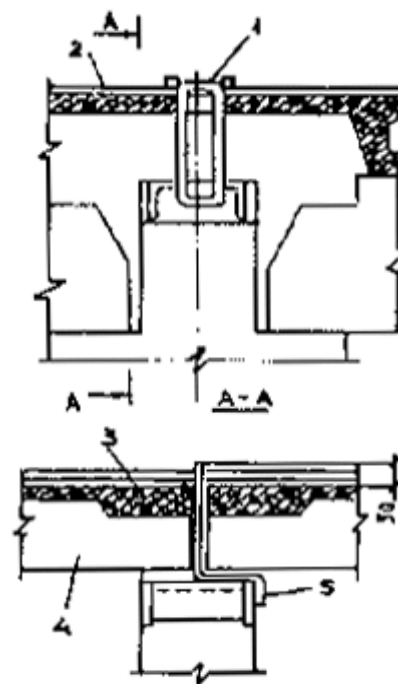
Узел в системе молниезащиты многоэтажного здания с прямоугольными железобетонными ригелями:
